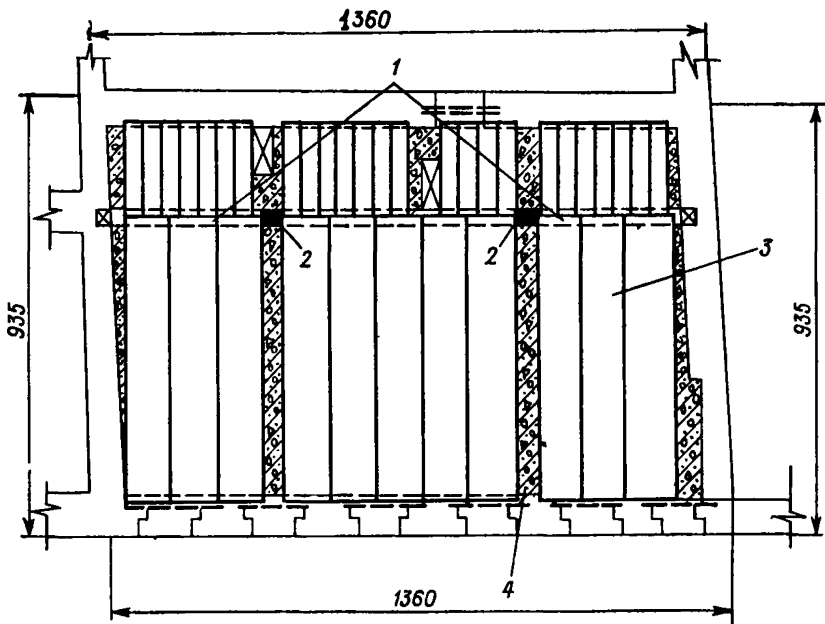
Конструкция сборного перекрытия из пустотелых настилов с устройством каркаса из крупноразмерных колонн и прогонов
